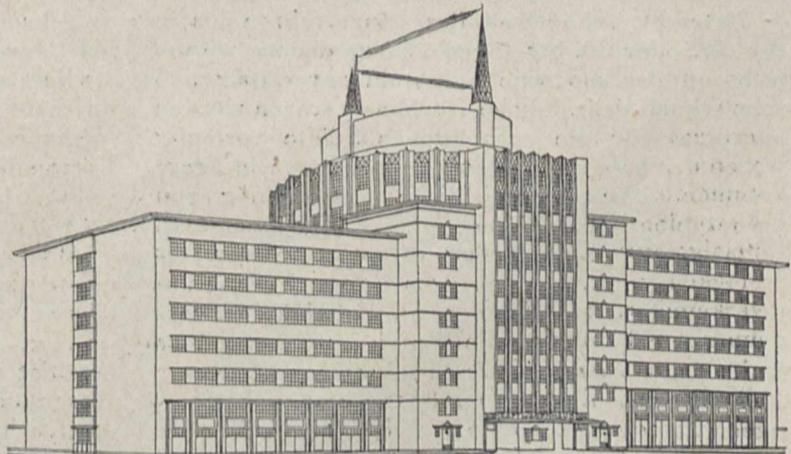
Entwurf eines Kraftwagenhauses mit getrennter Ein- und Ausfahrt.
